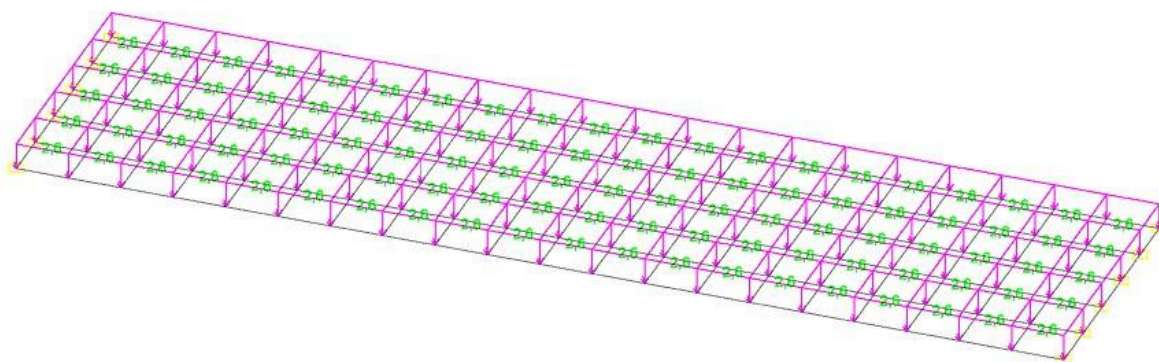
Схема загрузки плиты временной расчетной нагрузкой
